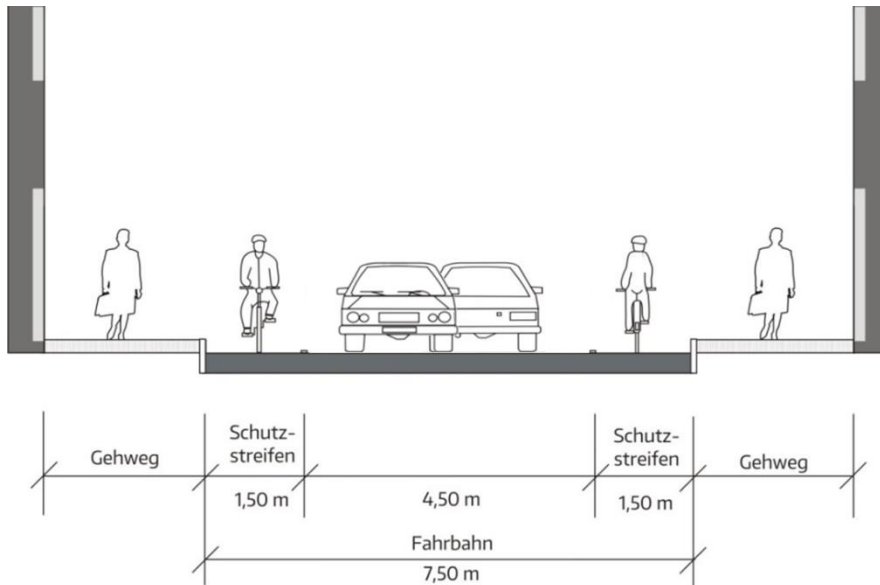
Flächenbedarf / Straßenraumaufteilung mit Schutzstreifen
